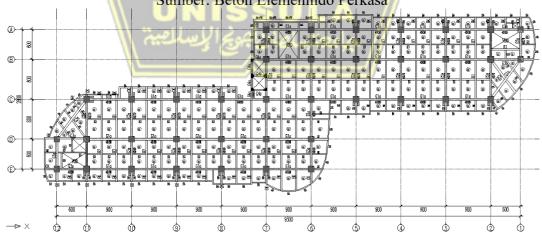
Denah Rencana Pelat Lantai 1 Sumber: DED Proyek
